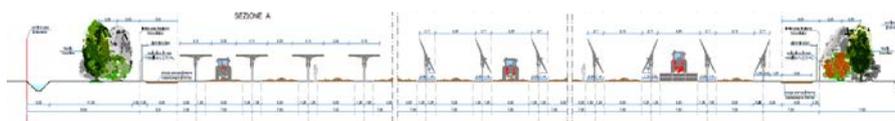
Fasce di coltivazione con i pannelli nelle posizioni orizzontale e verticale. Sezione – Stralcio
